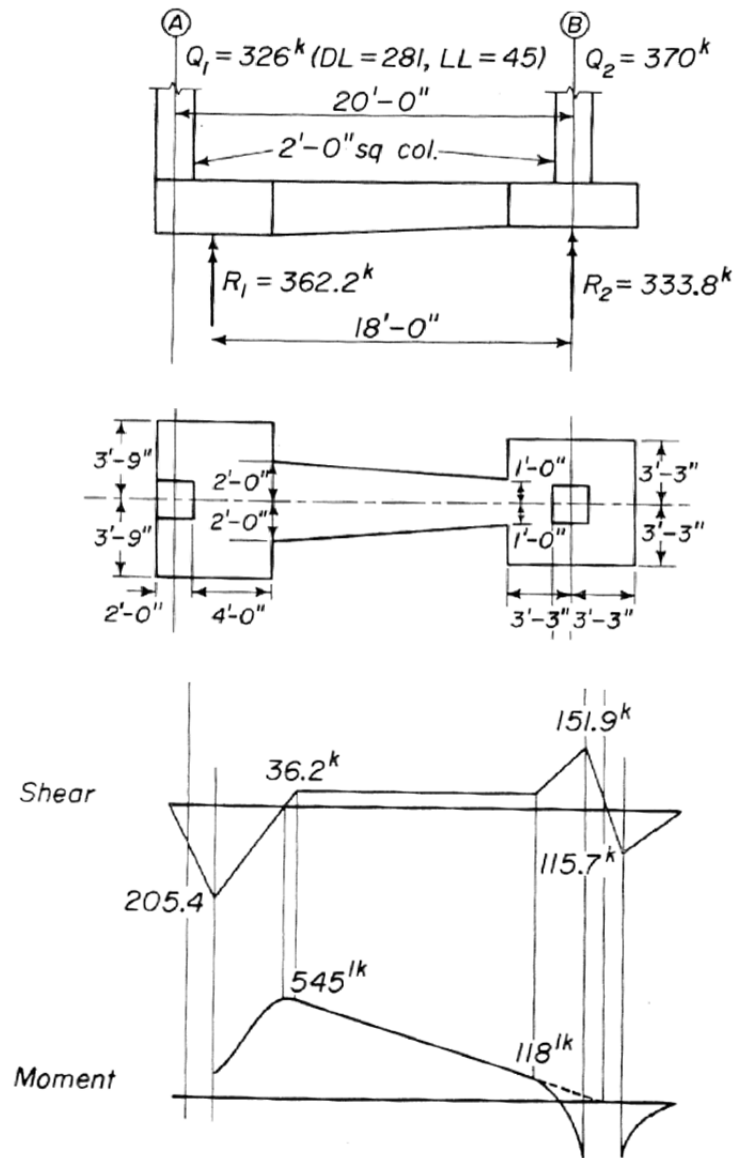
Diagramas de esfuerzos zapata aislada con viga riostra. Teng [10].
